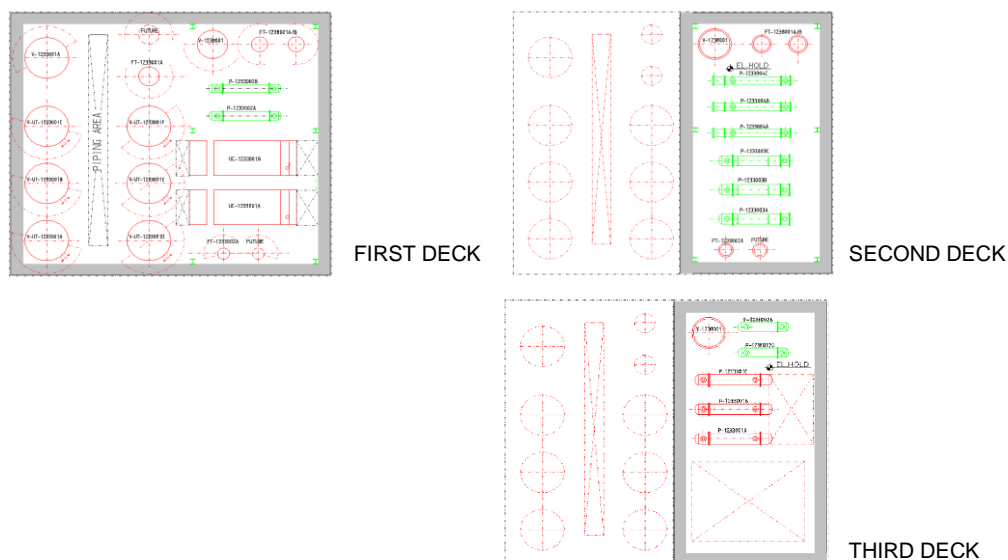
Exemplo de planta de arranjo de um módulo.
